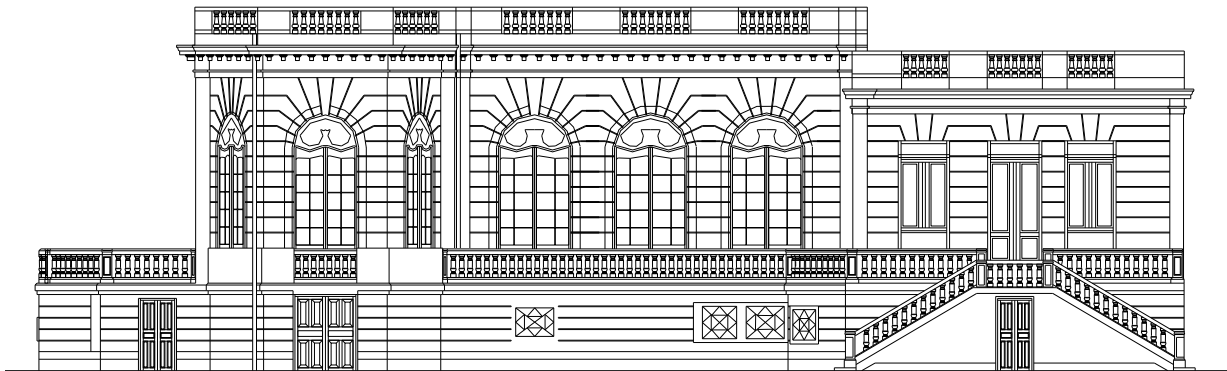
Fachada Oriente, Proyecto de Restauración de la Casa del Lago.
